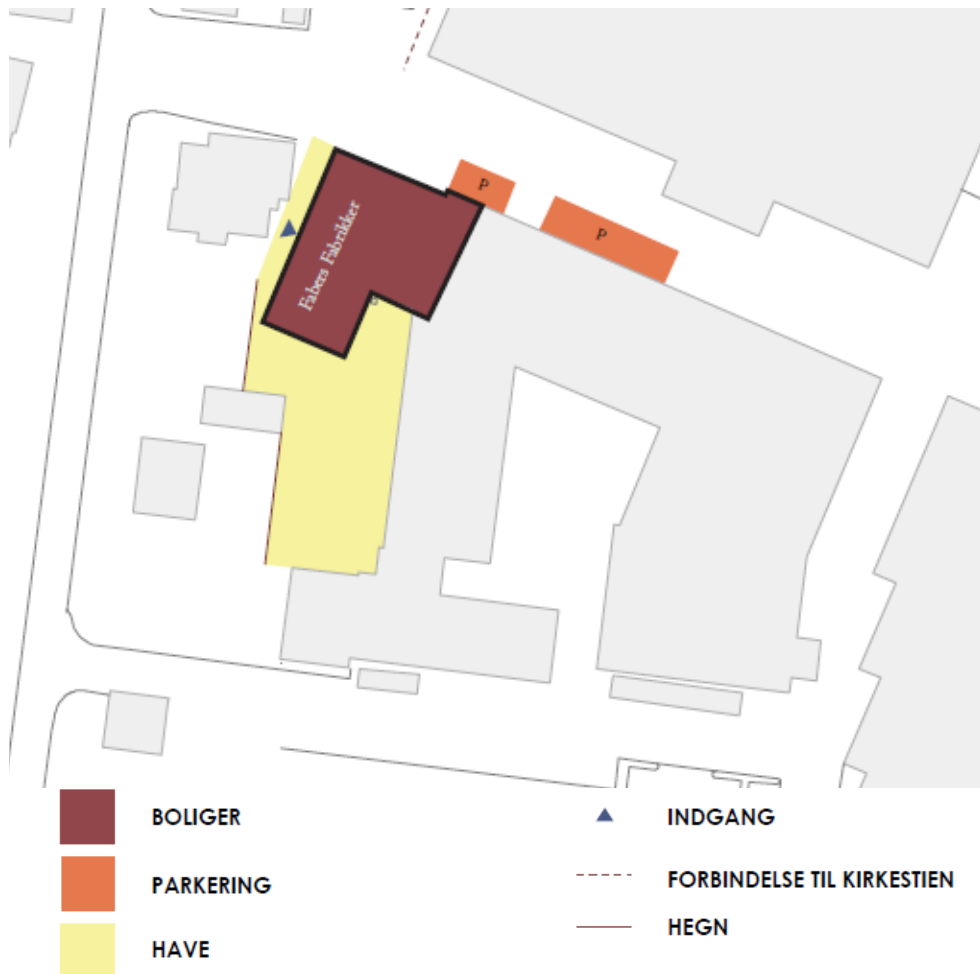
Situationsplan over Fabers Fabrikkers placering i Ryslinge og oversigt over bygningernes funktioner. Kilde: [Faaborg, A00].
